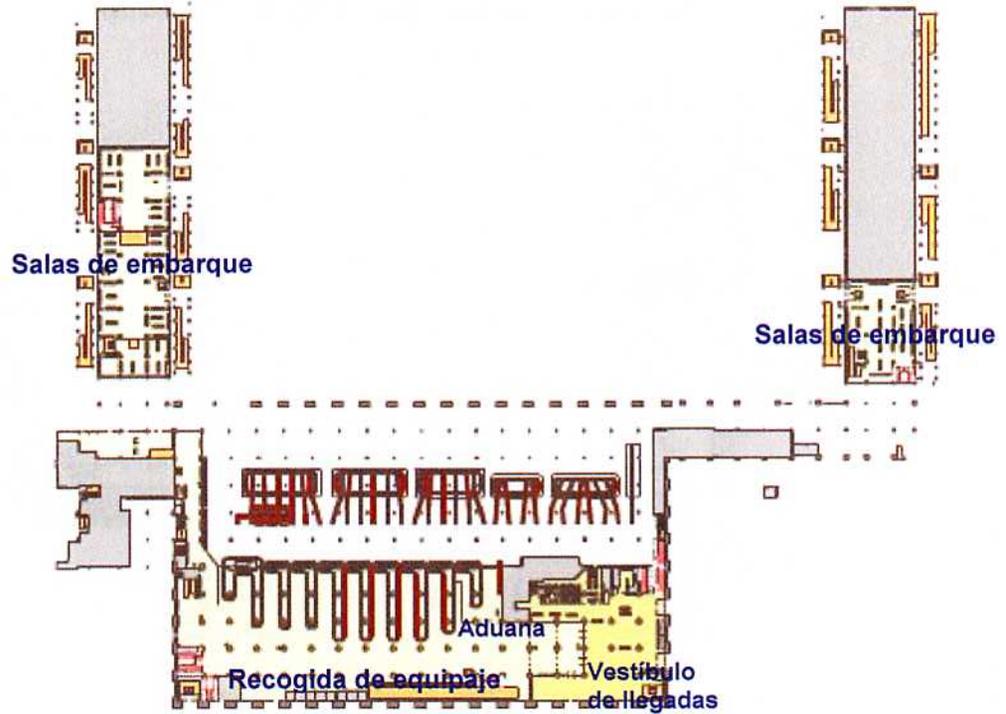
Planta intermedia (Nivel 04). Terminal T2
